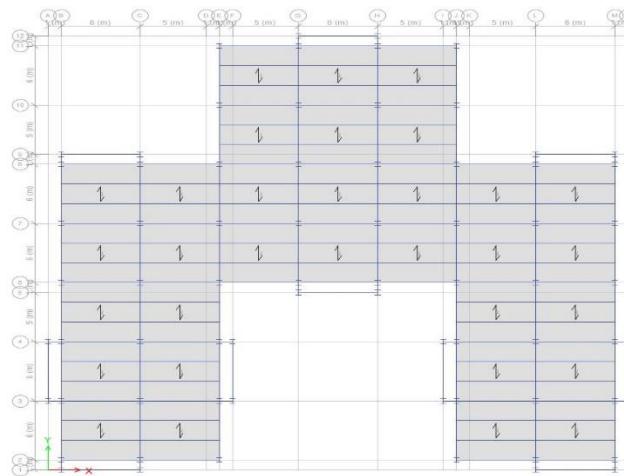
Denah lantai 1-3 Model 1 (Breising di sudut sudut bangunan)
